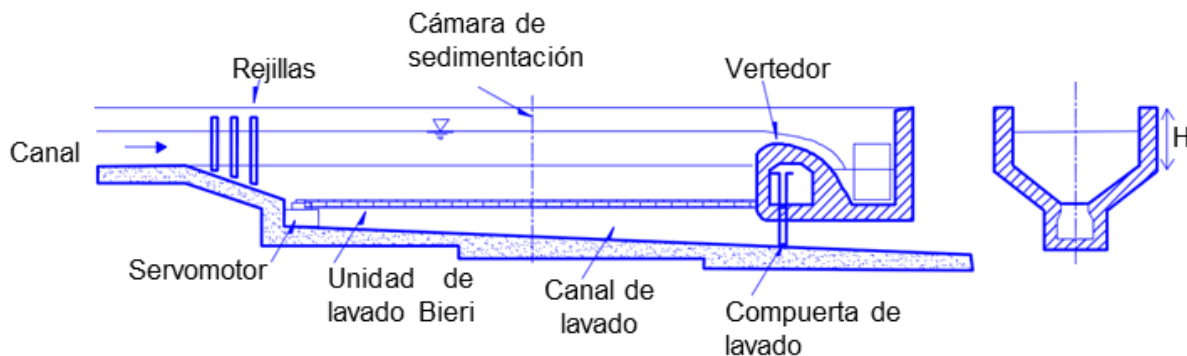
Planta y perfil de un sedimentador tipo Bieri. *Adaptado de (Andaroodi, 2006)
